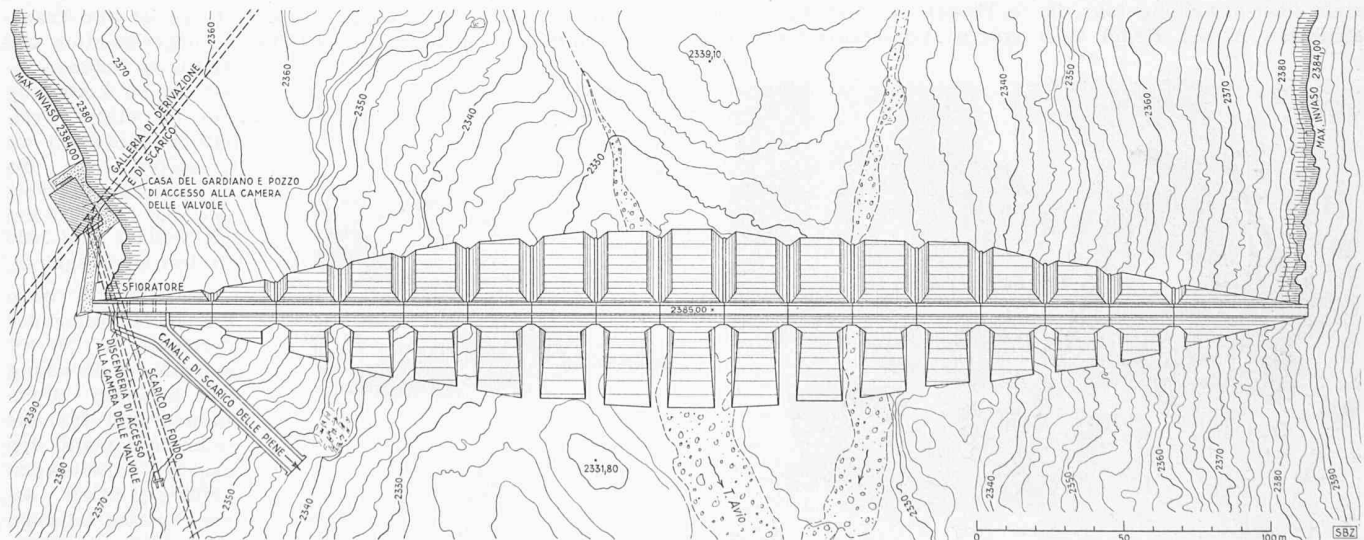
Pfeilerstauwehr für den Stausee Pantano d'Avio. Situation 1: 2500
